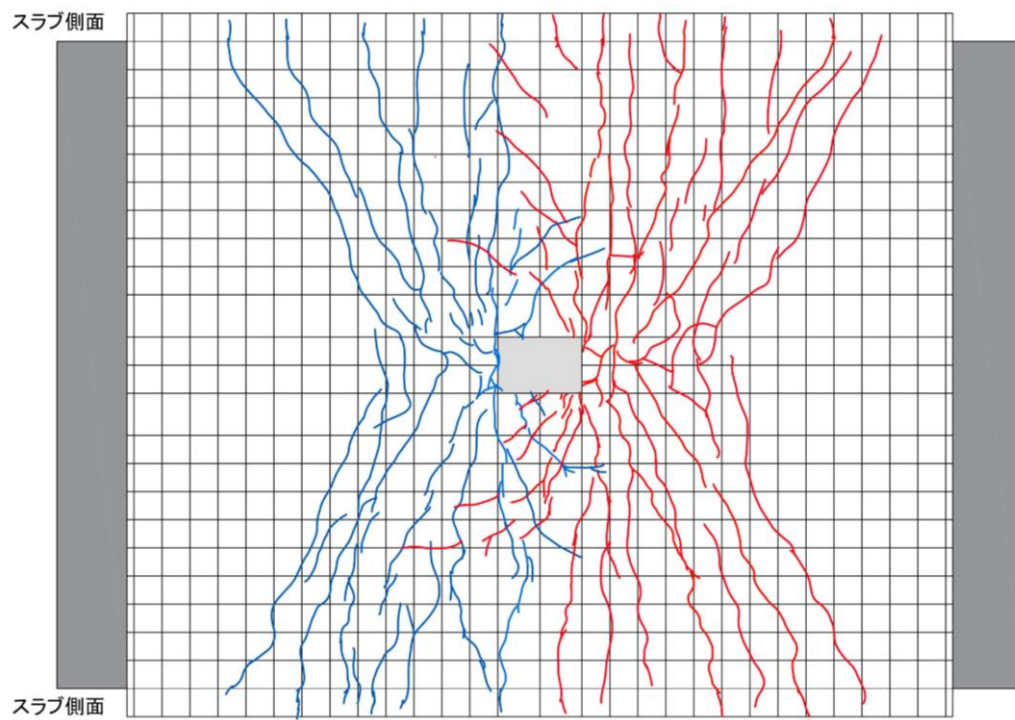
スラブ上面ひび割れ図(1/25rad)
